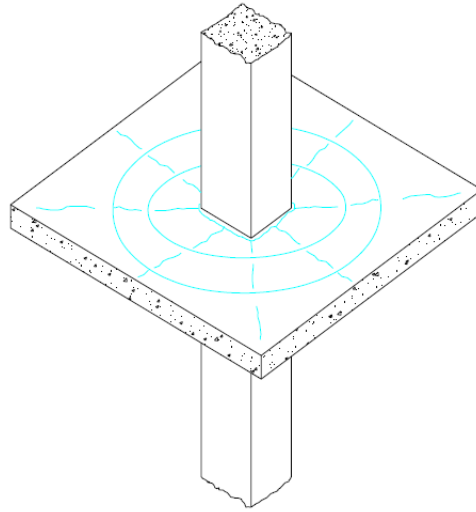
Punçoamento em Lajes Fungiformes [37]
